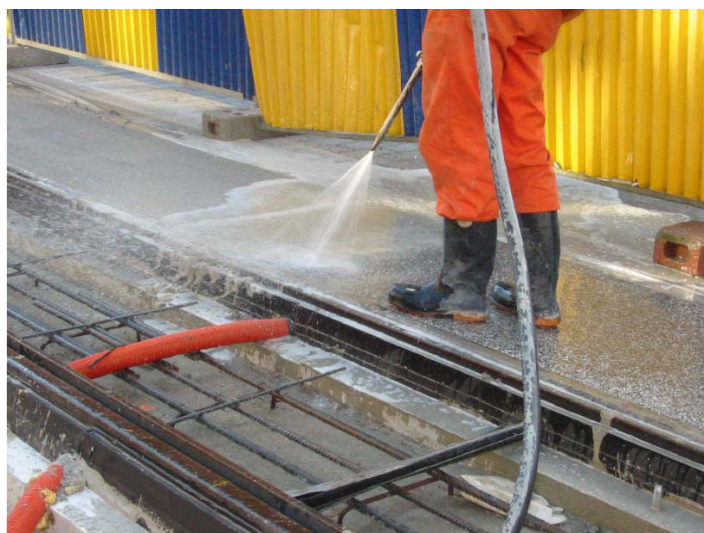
CURA DO CONCRETO – FONTE: FEBELCEM
